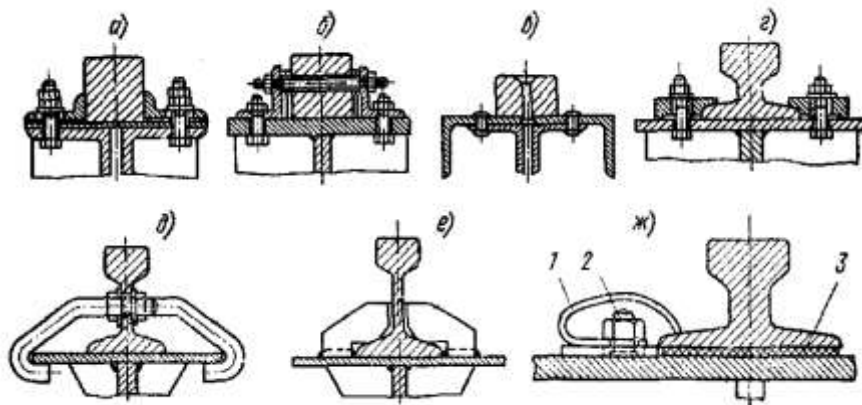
Крепления рельсов к подкрановым балкам:
